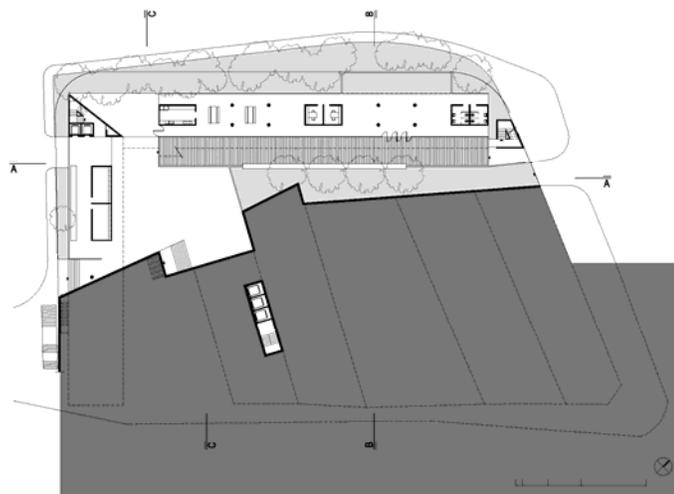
Planta: pavimento Viaduto D. Paulina (s/esc).
